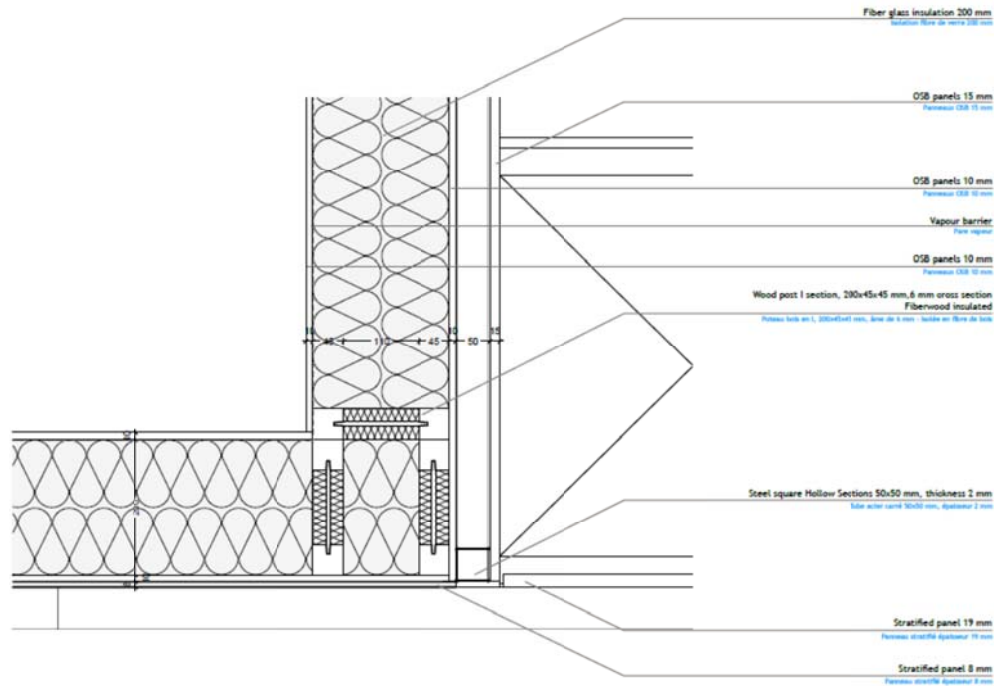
Detalle esquina fachada Sur. Fuente: GRE_CD_2010-09-22
